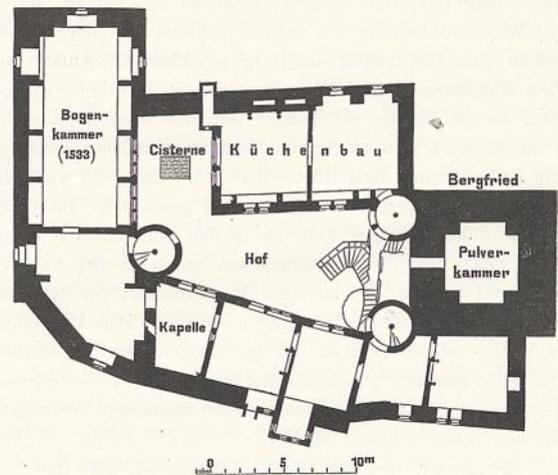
Grundriß des Hochschlosses. I. Stock.
